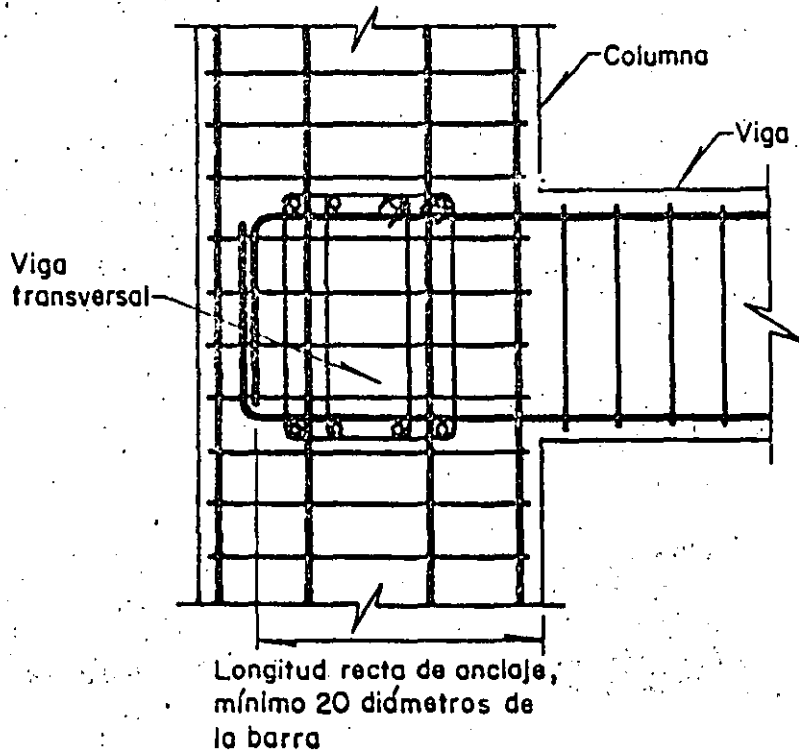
Ejemplo de unión viga-columna extrema según NTC del RDF87
